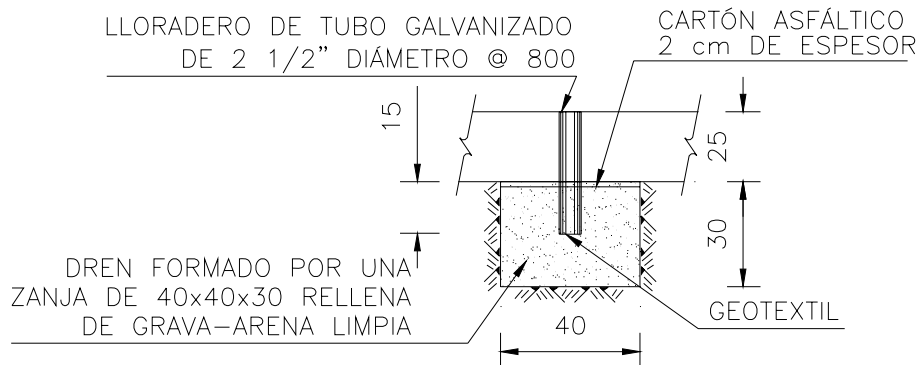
detalle de lloraderos colocados en el canal de descarga del vertedor
